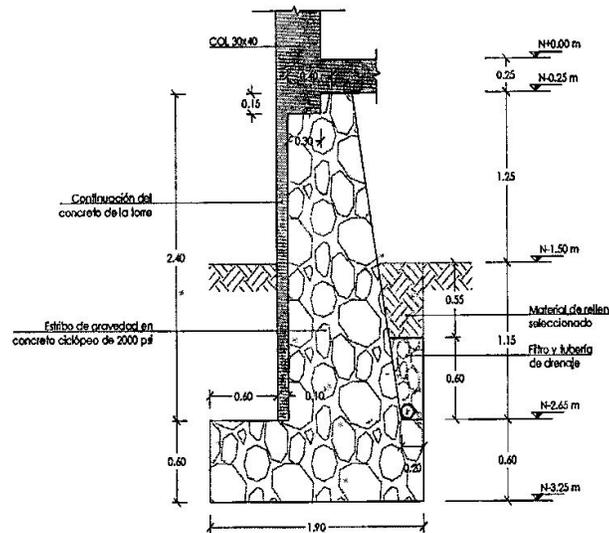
Detalle Estribo de gravedad de cimentación del puente colgante peatonal – Quebrada San Francisco¹⁰.
